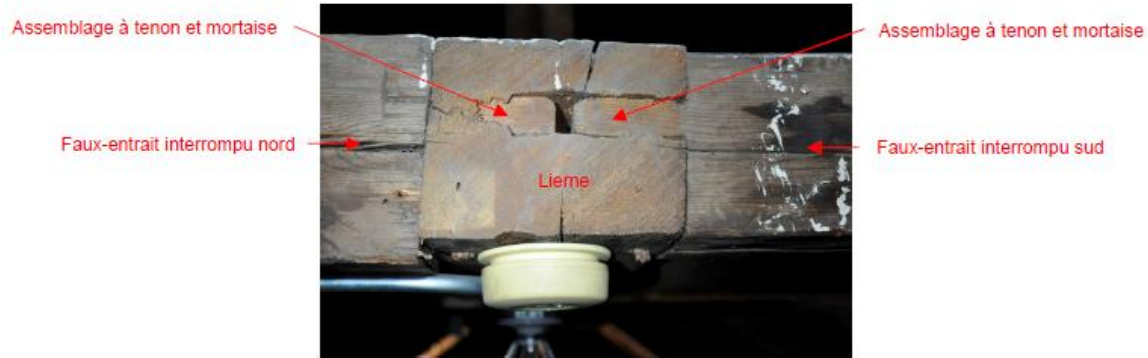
Lierne coupée transversalement à l'emplacement d'un assemblage avec un faux-entrait interrompu.
